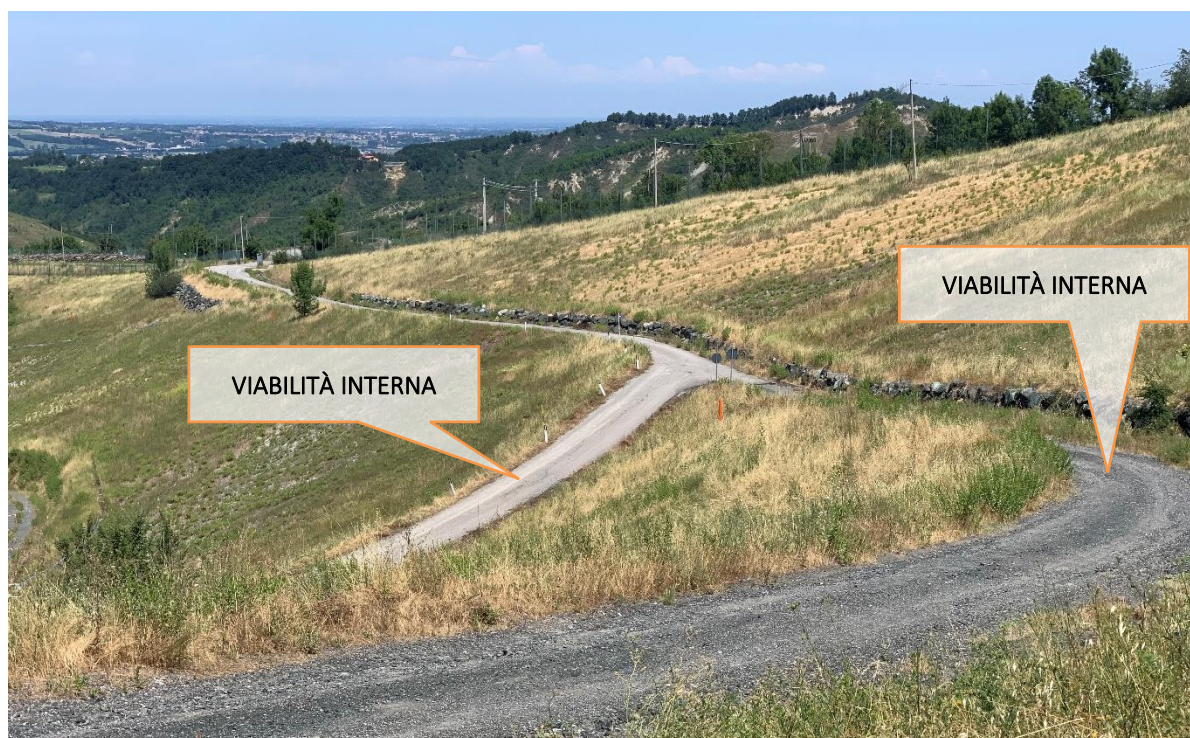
FOTO 08 - Vista della viabilità di accesso al corpo rifiuti (porzione di monte)
